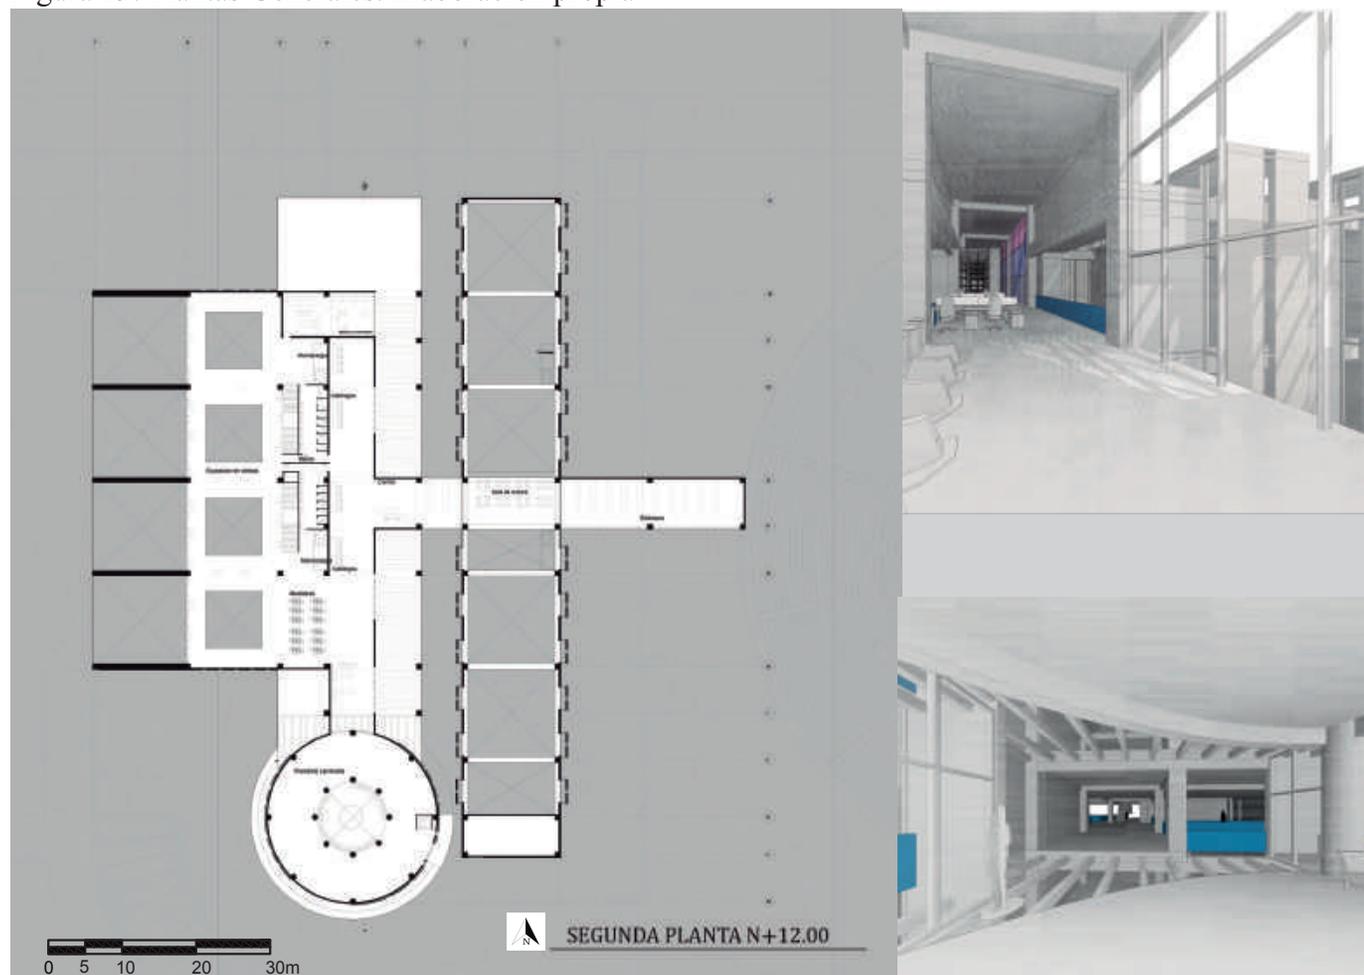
Plantas Generales/ Vistas interiores. Elaboración propia
